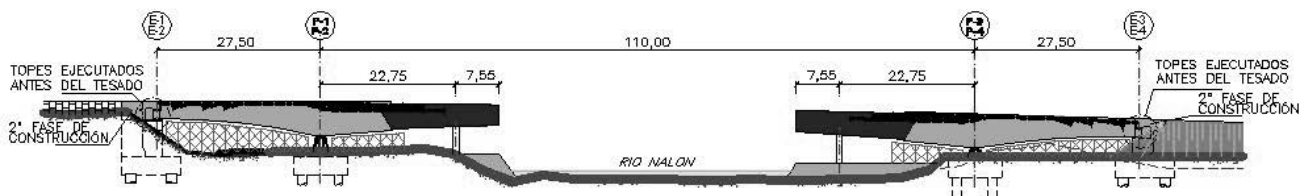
Ejecución de segunda fase de estribos con apoyos inversos, y pretensado del vano lateral cosiendo la junta con la estructura metálica.
